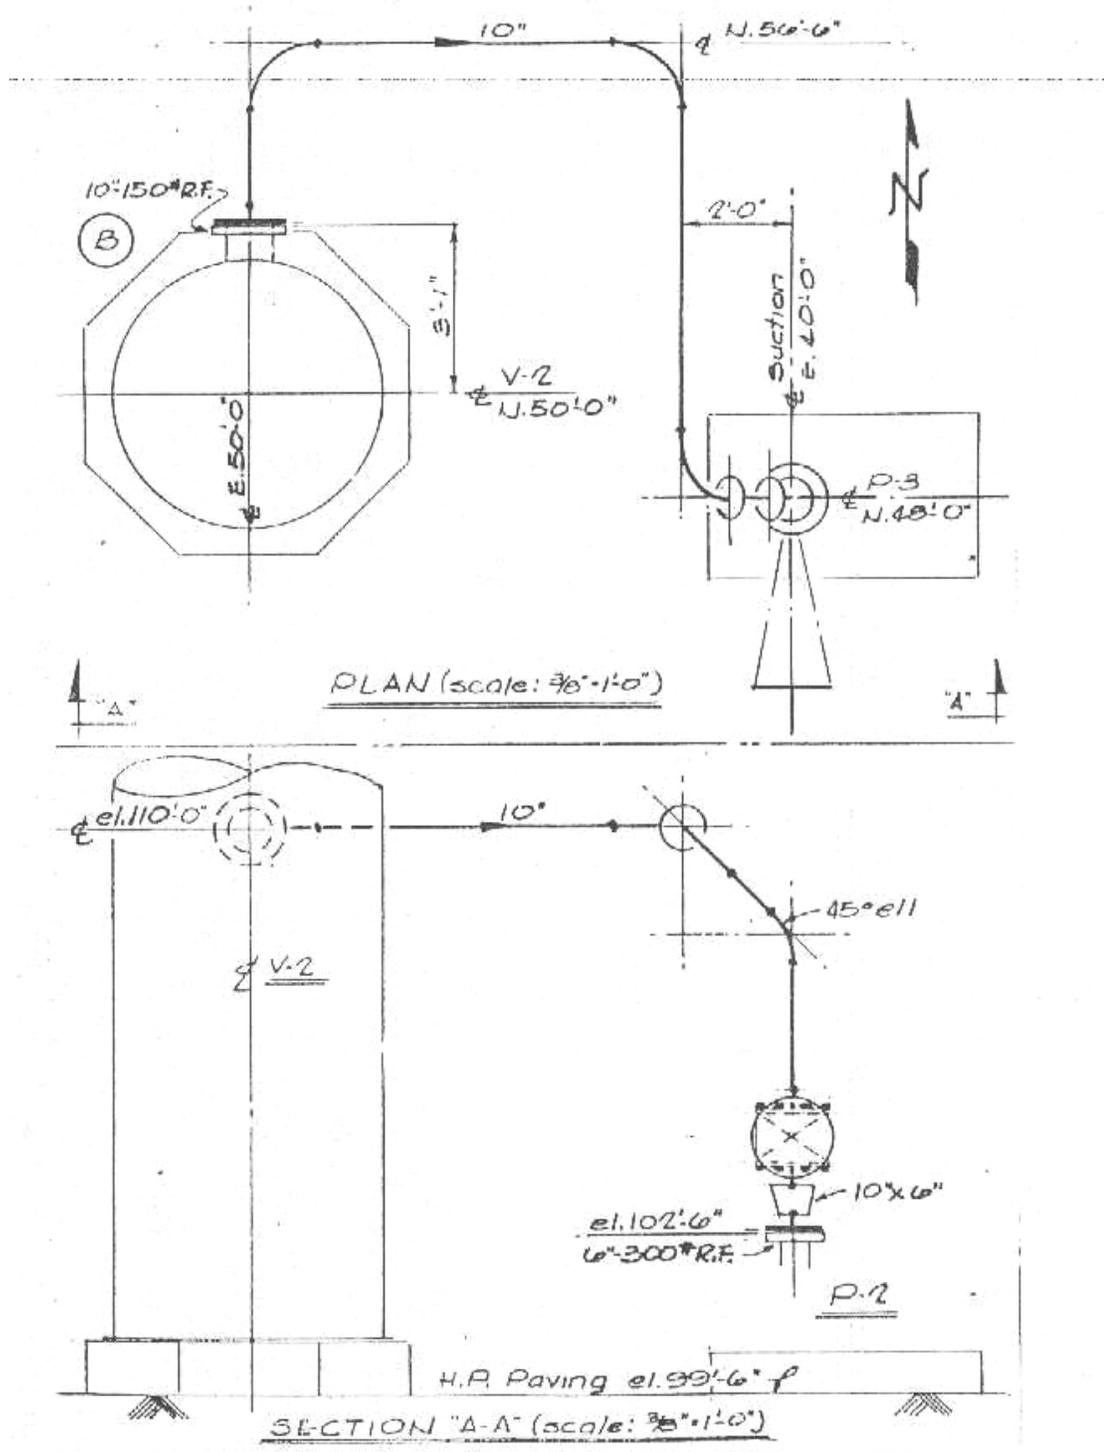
Plano de arreglo de conexiones de tuberías entre equipos donde se observa una vista en planta y sección del arreglo.
